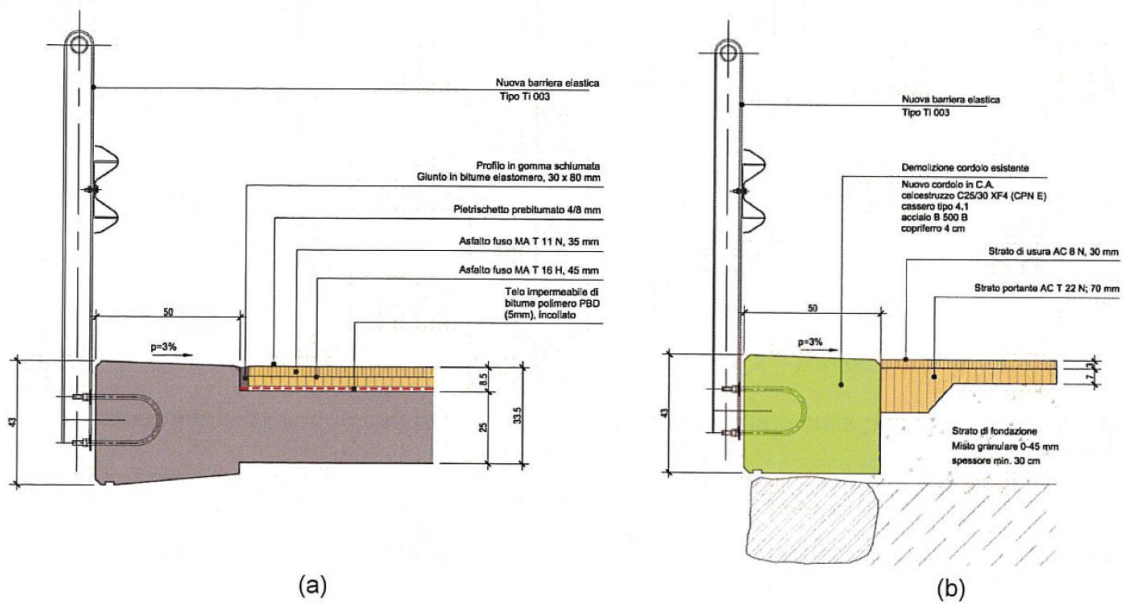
Progetto – dettaglio pavimentazione sul manufatto (a) e oltre la spalla (b)
